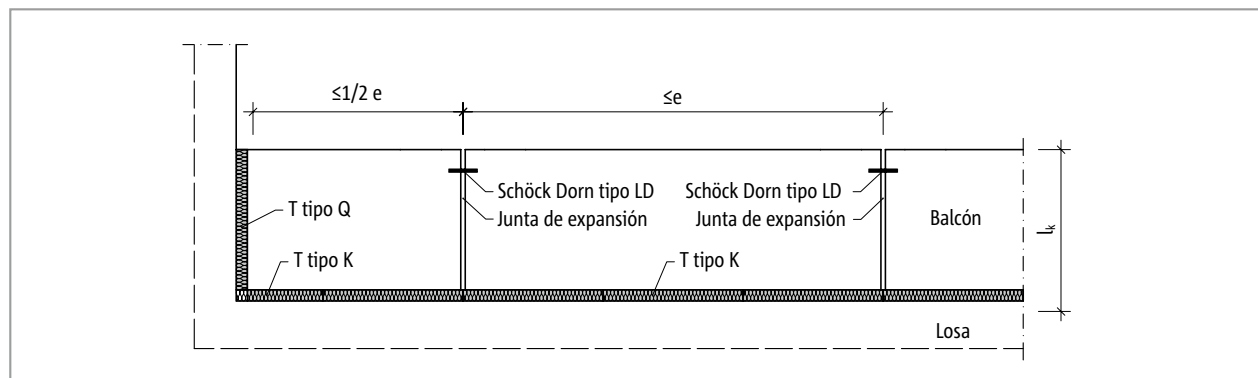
Schöck Isokorb® T tipo K: Disposición de las juntas de expansión
